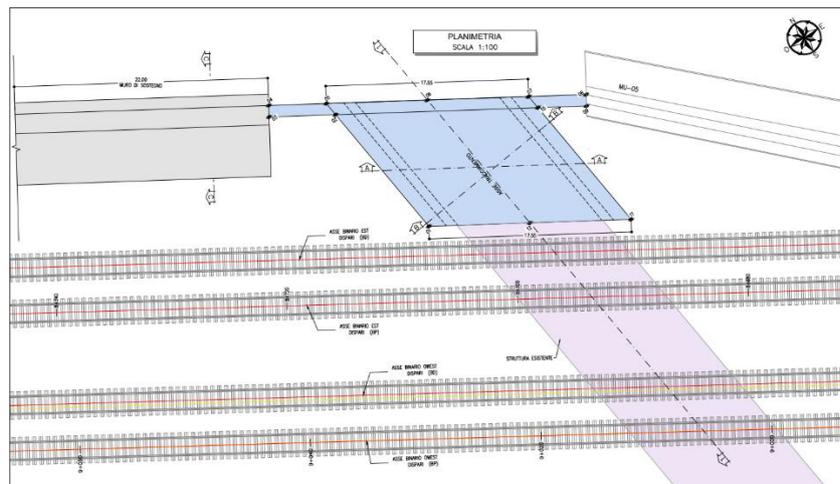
VI04 – Stralcio planimetrico manufatto di prolungamento
